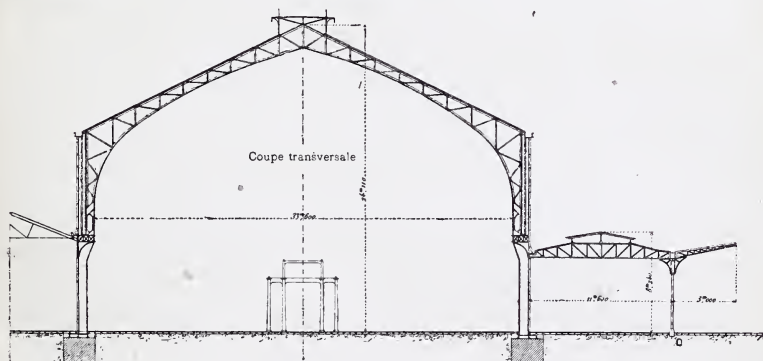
Exposition de 1878. — Galerie des Machines.
